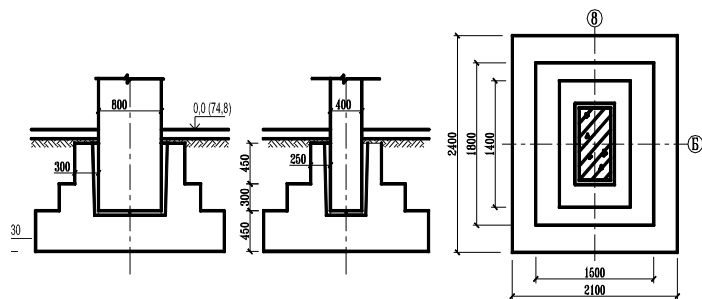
Пример конструкции монолитного фундамента в осях 8 Б.
